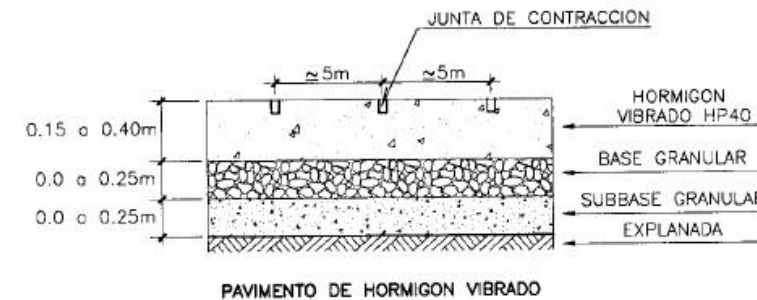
IMAGEN VII. PERFIL FIRME ZONA DE VARADA
